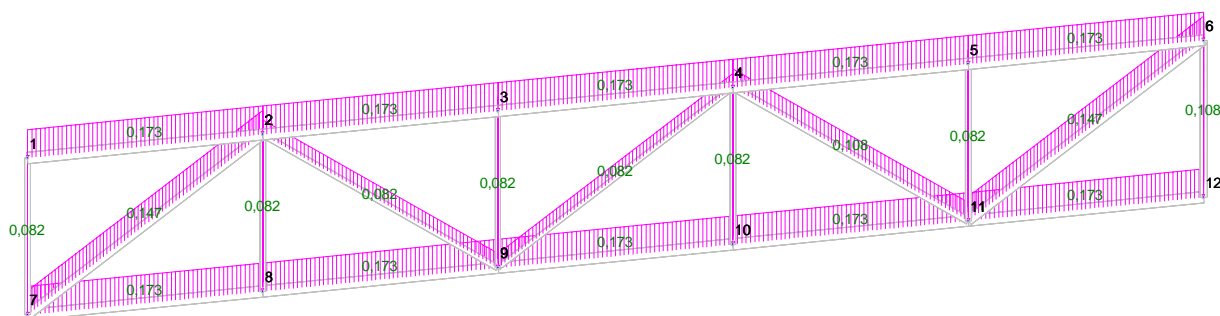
Нагрузка от собственного веса фермы
